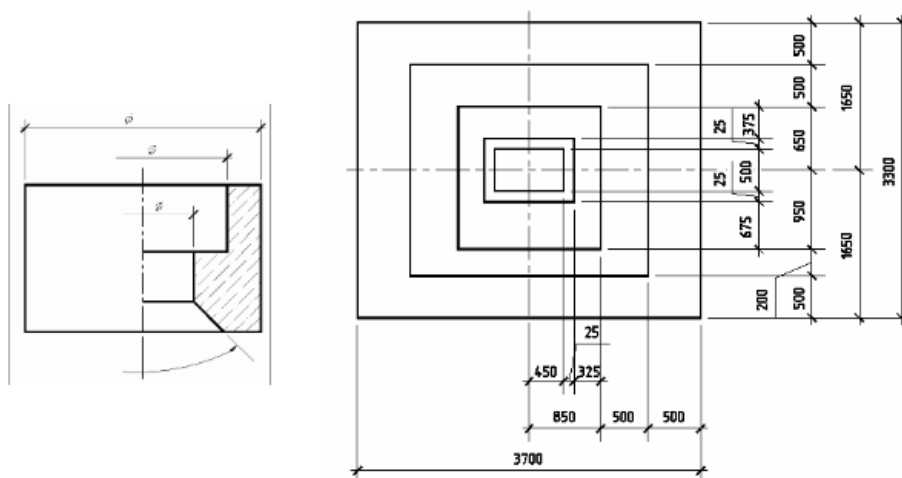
Нанесение размеров на чертежах симметричных изделий (узлов, конструкций и т.п.)
